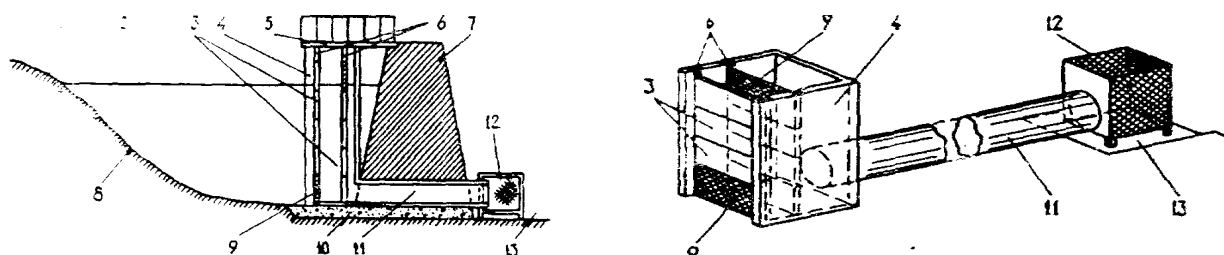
Схема реконструкции пруда (а) и водоспуск, или "монах", с шандорами (б): 1 - поверхность земли; 2 - уровень воды; 3 - шандоры; 4 - стояк водоспуска; 5 - мостик к "монаху"; 6 - пазы для шандор и сеток (швеллер); 7 - плотина из выемки грунта; 8 - поверхность дна; 9 - решетка; 10 - вы-
